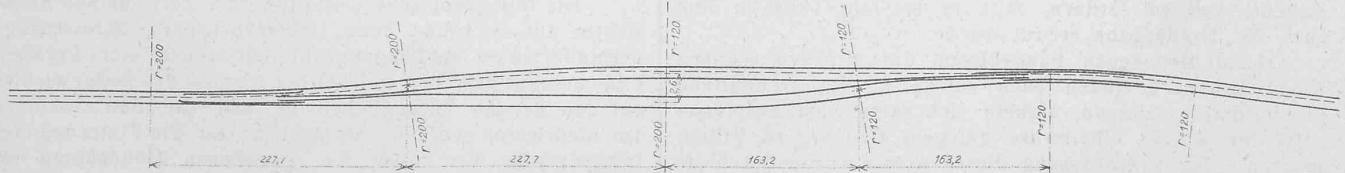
Lageplan der Ausweichestelle. — Maßstab 1 : 1500.
